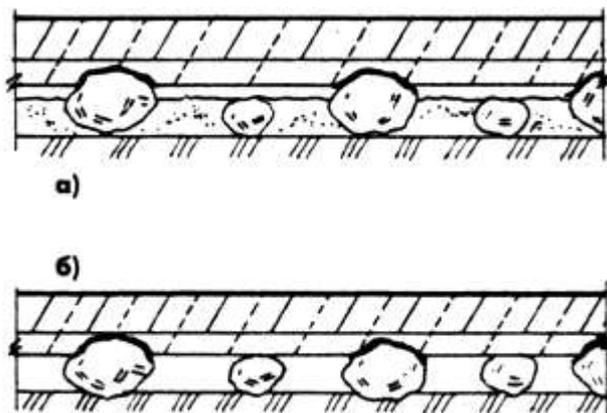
Поперечный разрез сейсмостойкого фундамента до осадки здания (а) и после стабилизации осадок (б)
